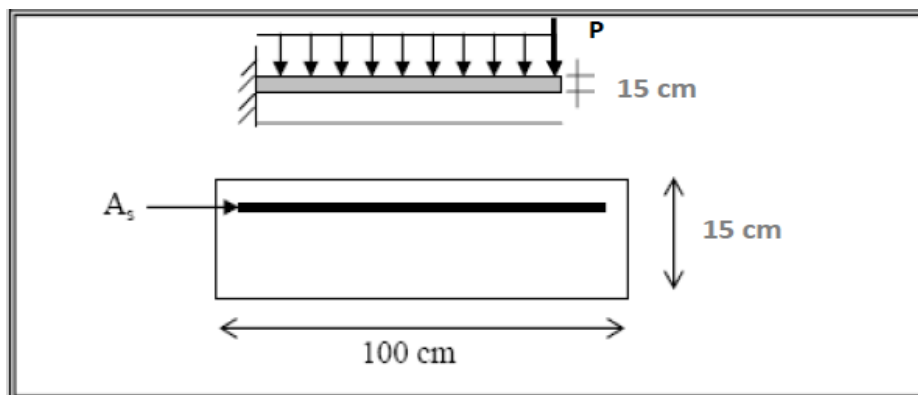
Section théorique pour le ferrailage du balcon.
